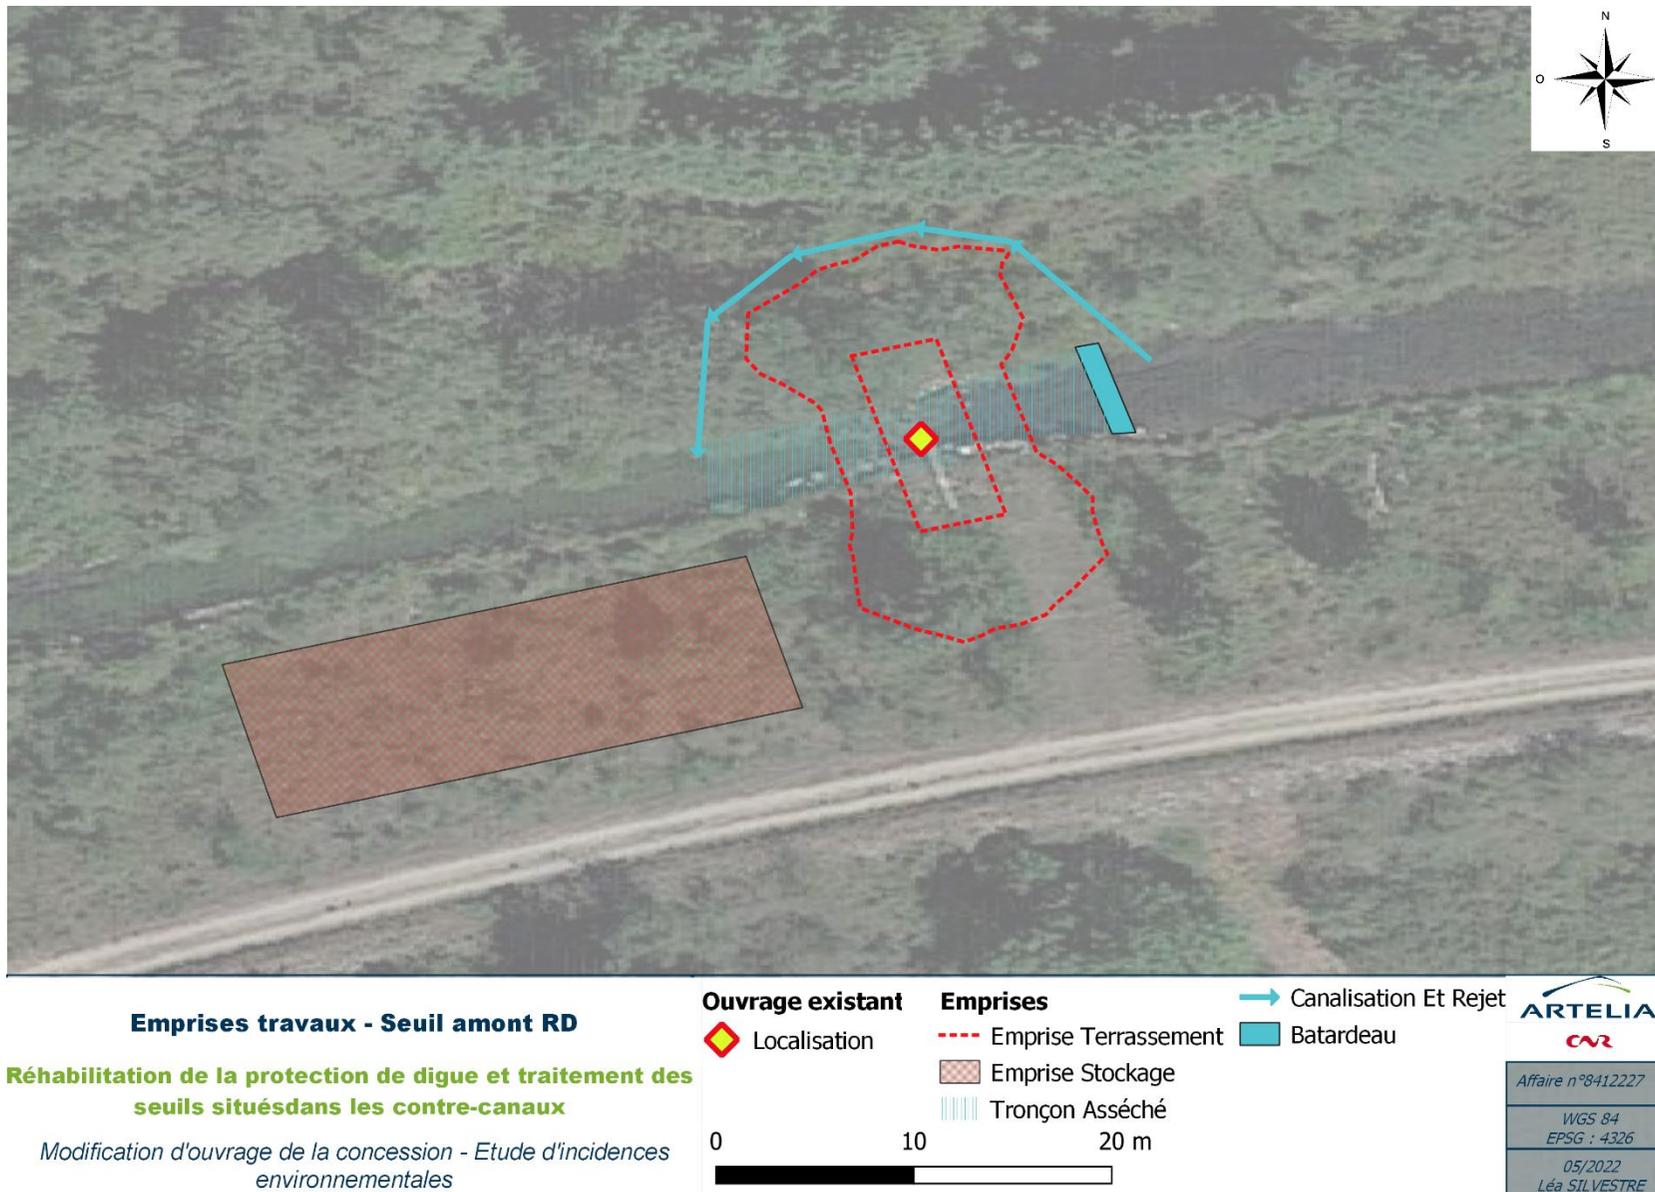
Emprise des travaux - Ouvrage RD Amont
